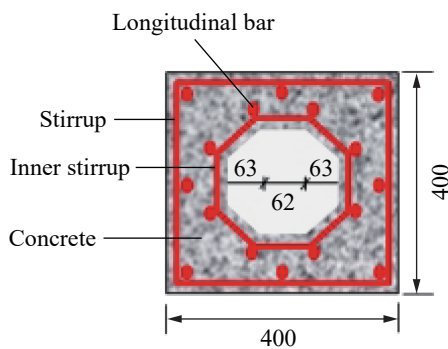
空心钢筋混凝土柱 RA3-5 剖面图(mm)
